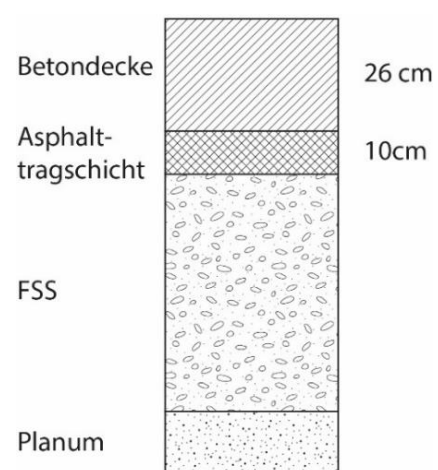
Lkw-Stellflächen einer T+R-Anlage nach Neubau mit Betondecke auf ATS auf FSS
